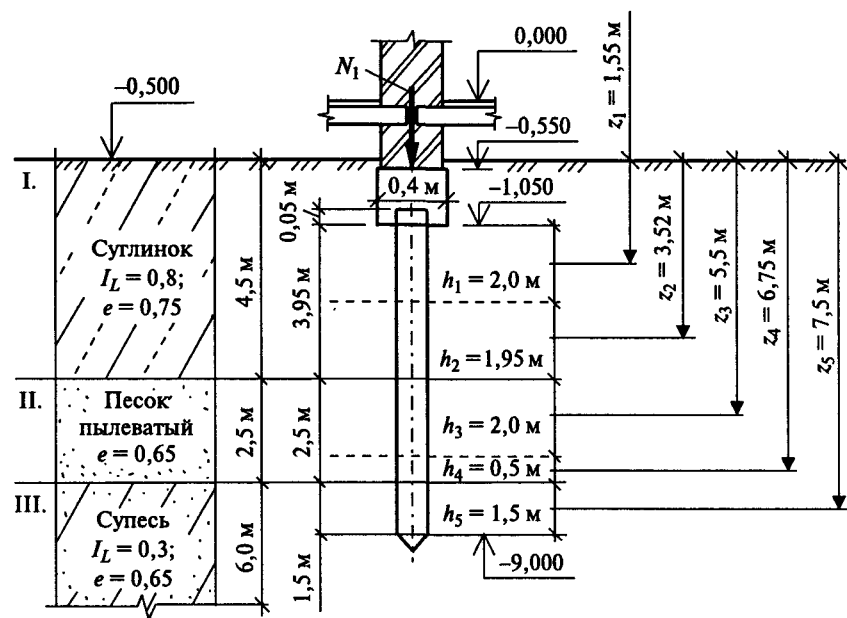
Грунтовые условия, размеры ростверка — к примеру 12.7
